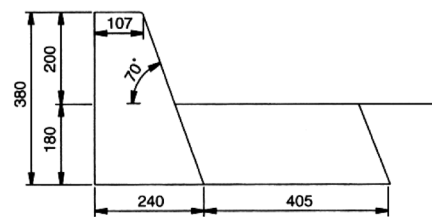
Perfil do lancil modelo “Marshall” (dimensões em mm) In Tyler, N. - “Accessibility and the Bus System: from concepts to practice”. University College London, UK, Thomas Telford Publishing, 2002, pp. 169
